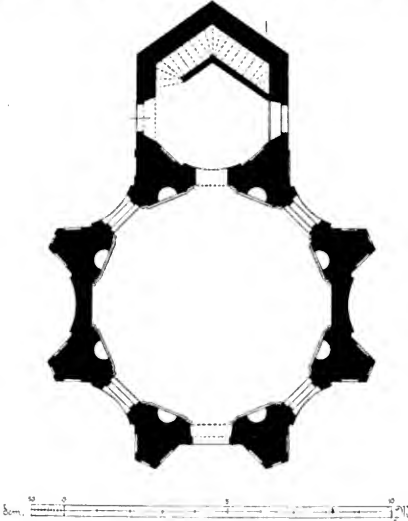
Čelýš. Grundriss der Kapelle.
